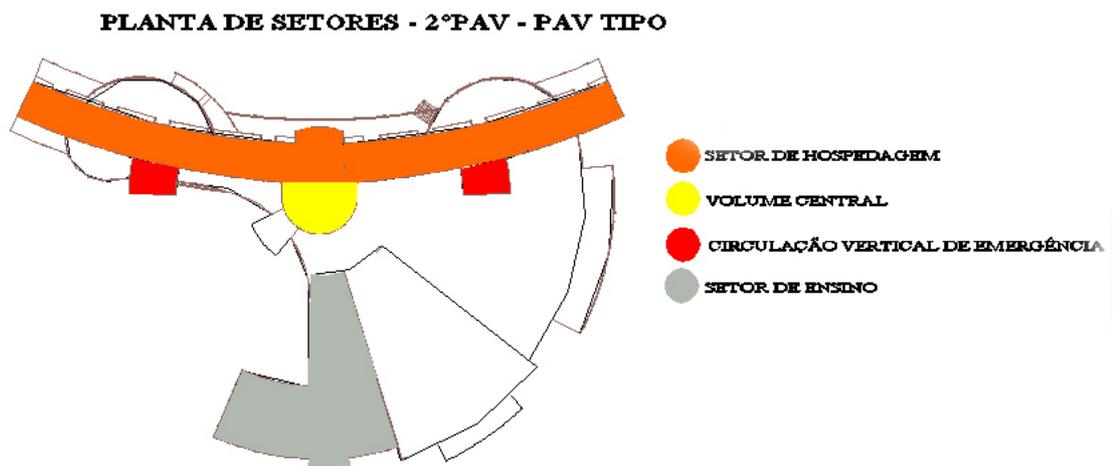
Diagrama – Planta de setores Pav. Tipo. Fonte: LEITE, Leandro S. TFG, UFSM, 2002
